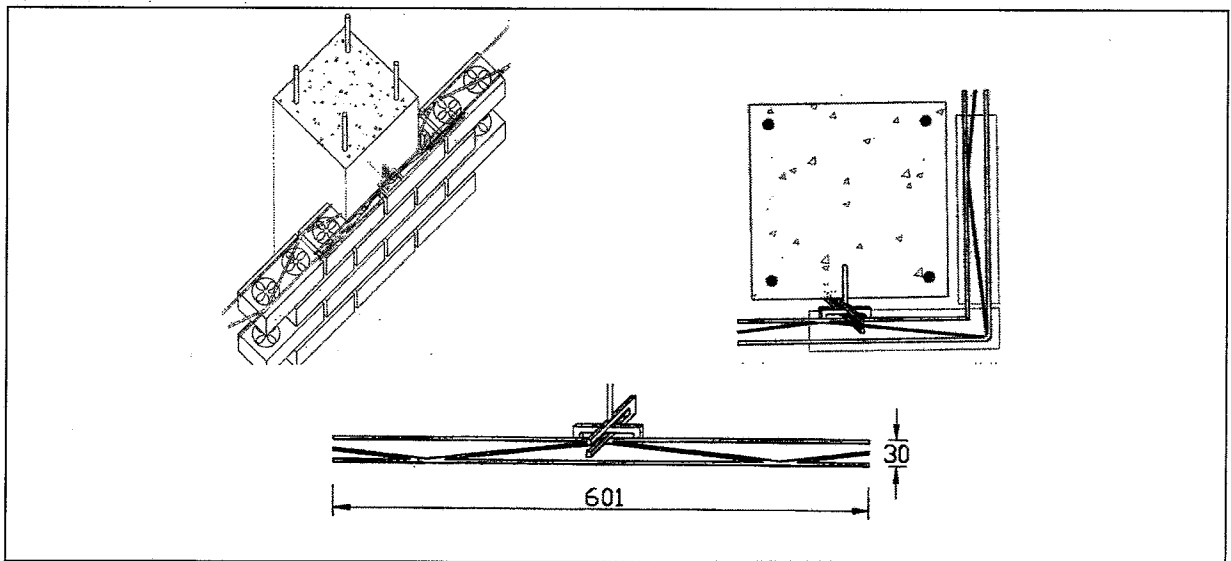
Armadura de juntas horizontais em zona de forra cerâmica [55]
